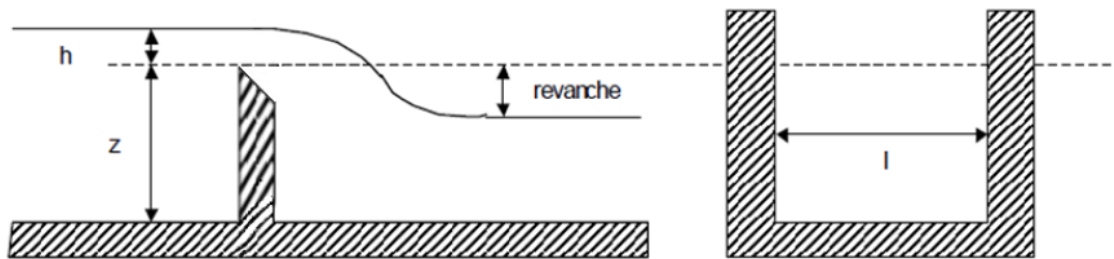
coupe longitudinale et transversale d'un déversoir frontal
